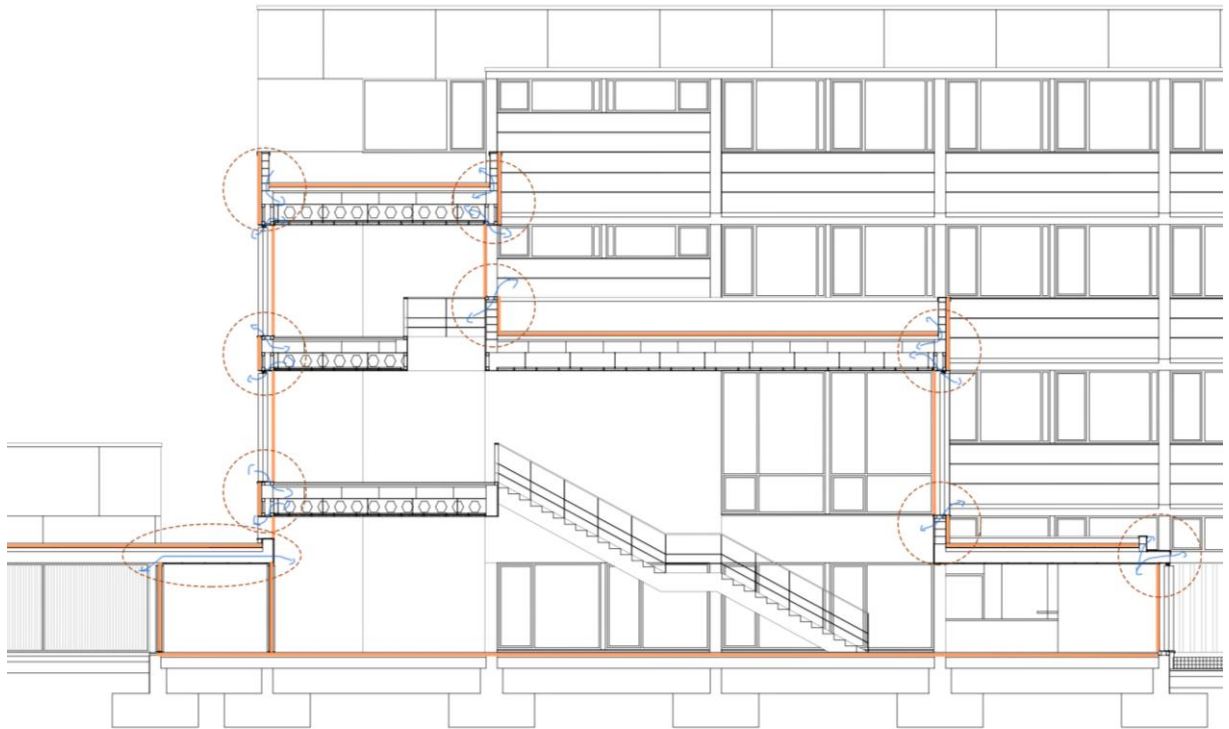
Identificación de puentes térmicos en sección por hall acceso. Fuente: Elaboración propia
